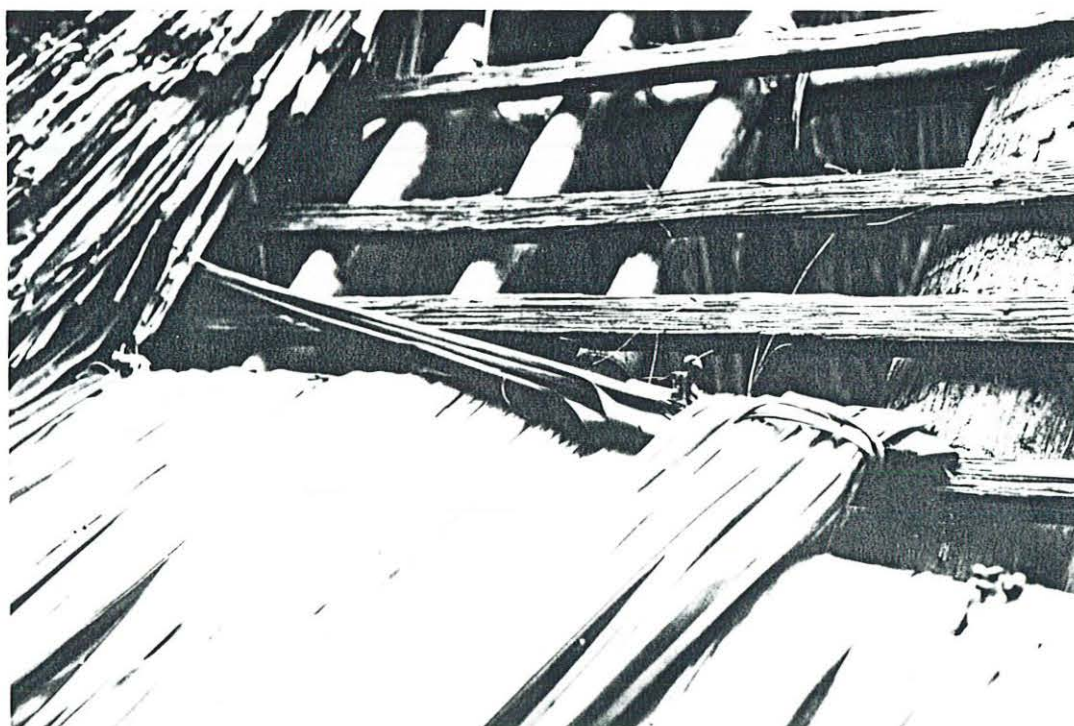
Gros plan sur la fixation d'une plaques de toiture.
